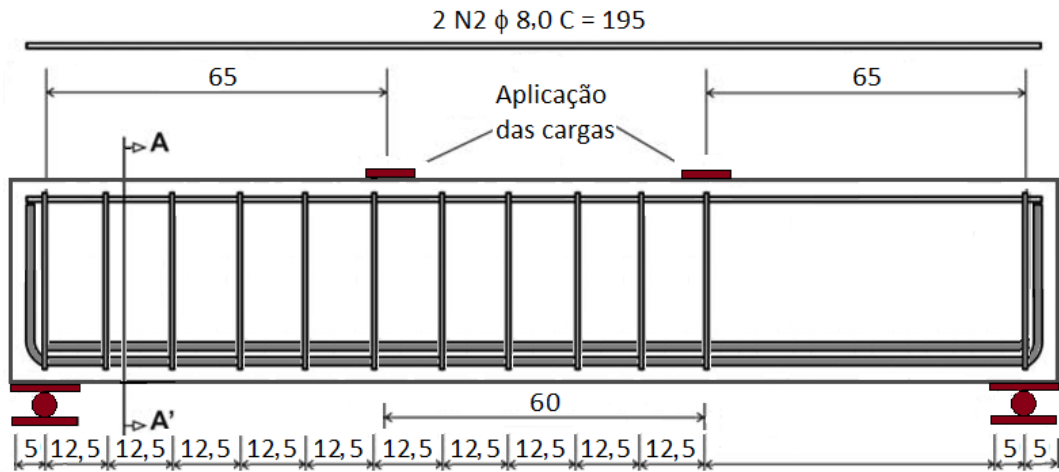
Configuração longitudinal das vigas do Tipo 1, 2 e 3 (dimensões em centímetros, exceto diâmetros que estão em milímetros).
